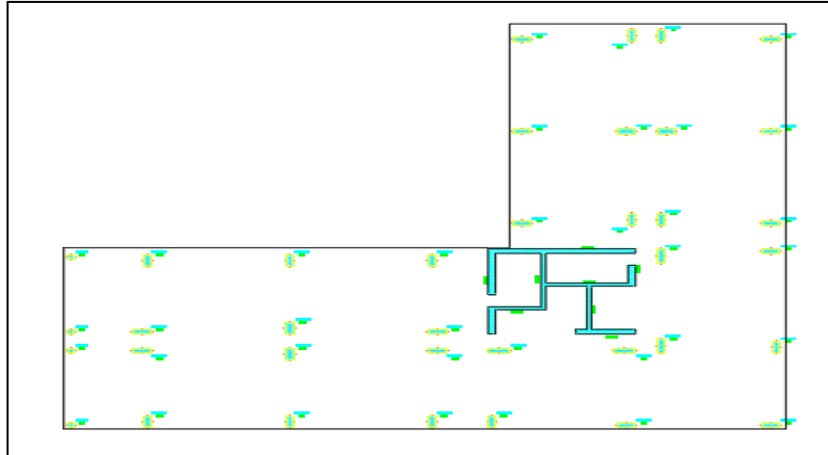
Diseño en AutoCAD de losa del Proyecto Entre Bosques
